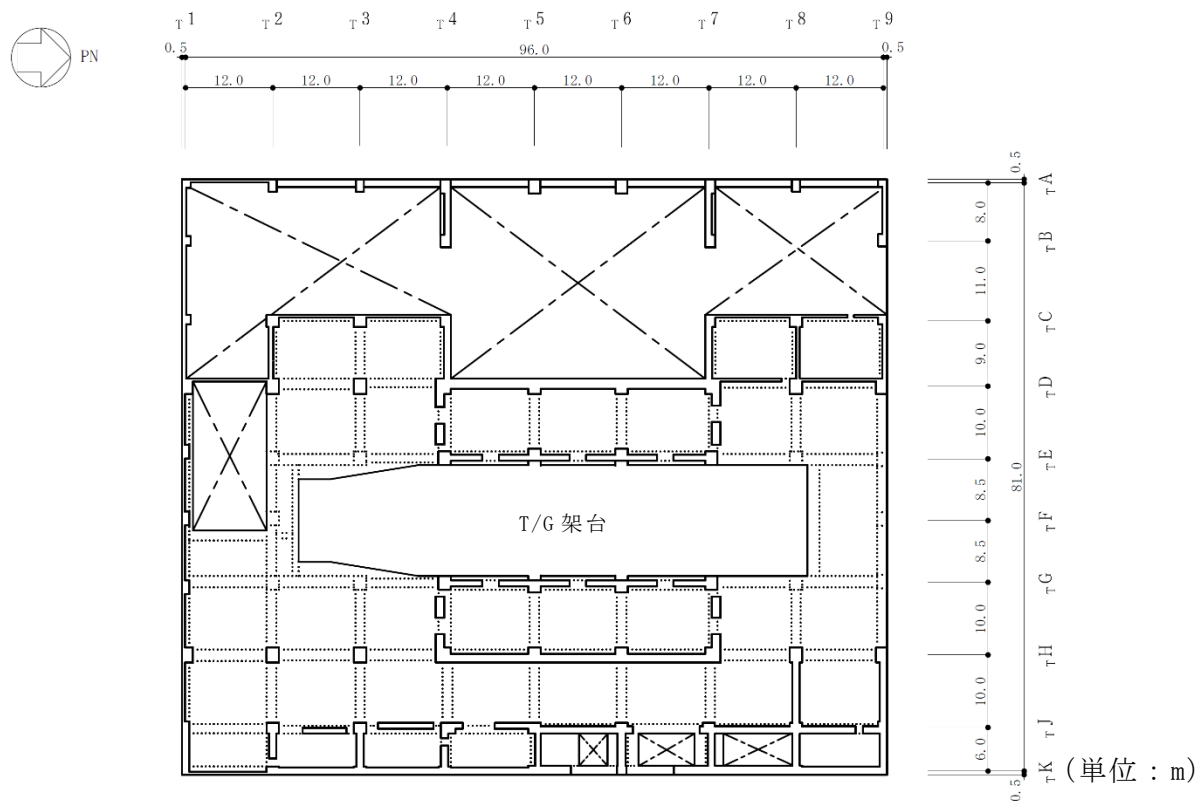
タービン建屋の概略平面図 (2F, T.M.S.L. 20.4m) (4/6)
